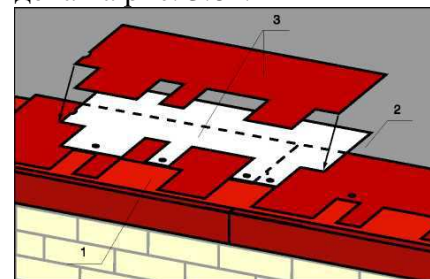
Укладка рядовой кровельной черепицы тип ROCKY
